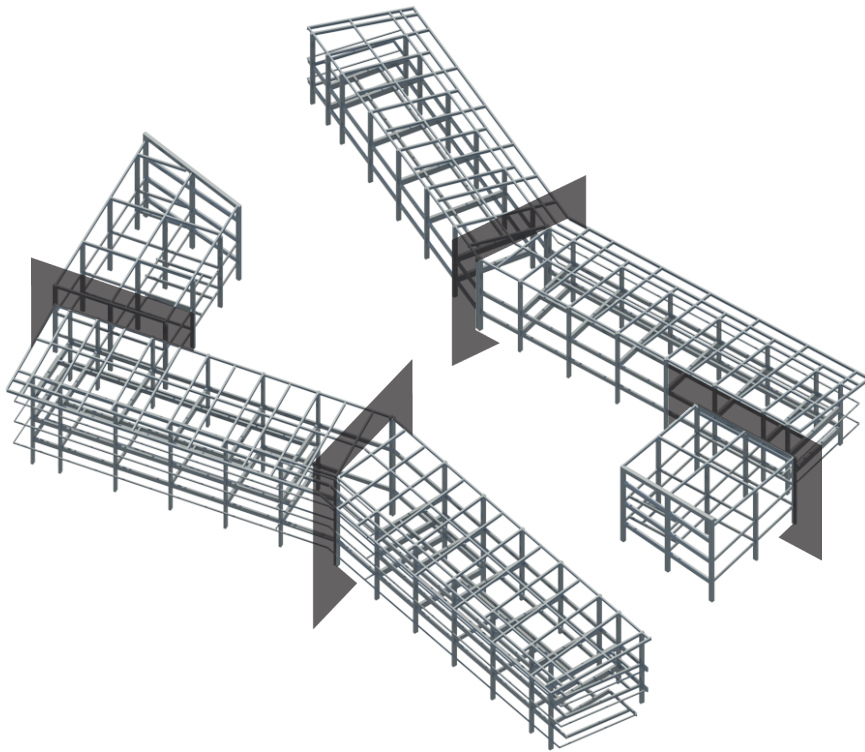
Para las alas que contienen los laboratorios se utiliza un sistema estructural de columnas y vigas de concreto creando un anillo discontinuo. Debido a las largas distancias que se manejan de extremo a extremo del edificio se plantean juntas estructurales de separación en los cambios de dirección de la estructura para mantener la integridad estructural del conjunto.
